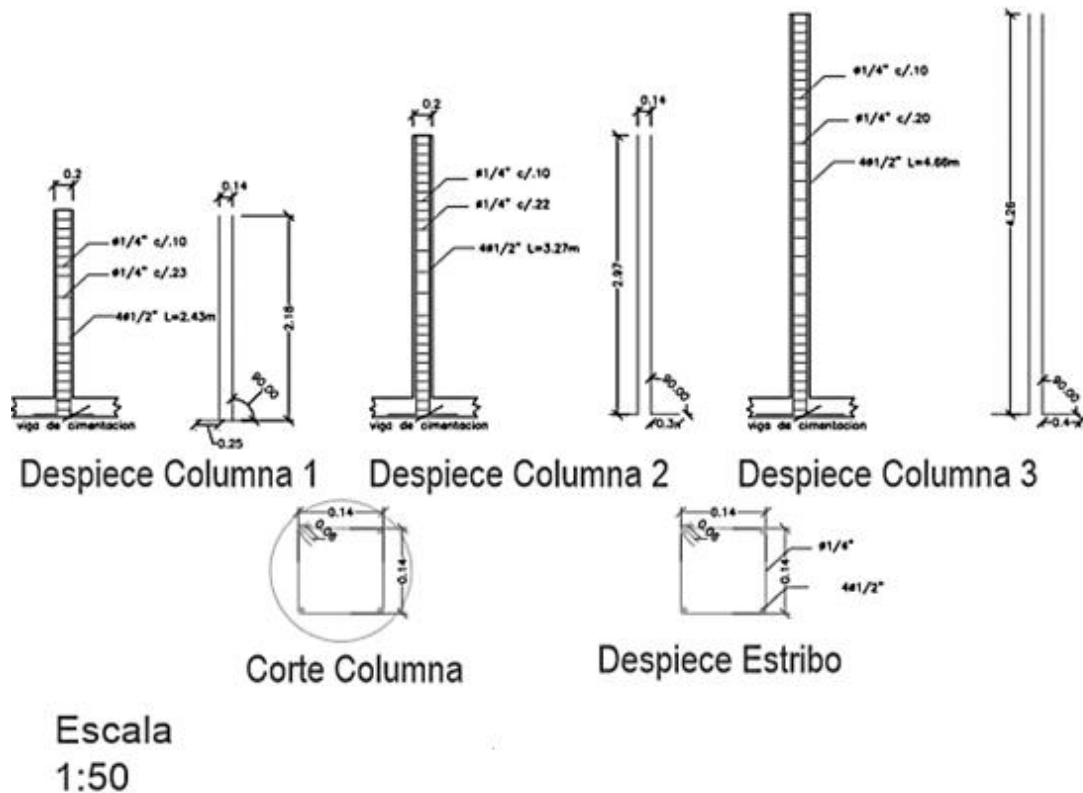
se observa el despiece de las vigas de amarre y de las columnas. Para realizar este despiece se tomó en cuenta el capítulo E. 4 “elementos de confinamiento en mampostería confinada”, en uno de sus apartes nos indica que las columnas de confinamiento deben anclarse a la cimentación y deben rematarse anclándose a la viga de amarre superior. Las dimensiones de las columnas en su sección transversal de las columnas deben tener un área no inferior a 200cm^2 , deben colocarse columnas en los extremos de los muros.
